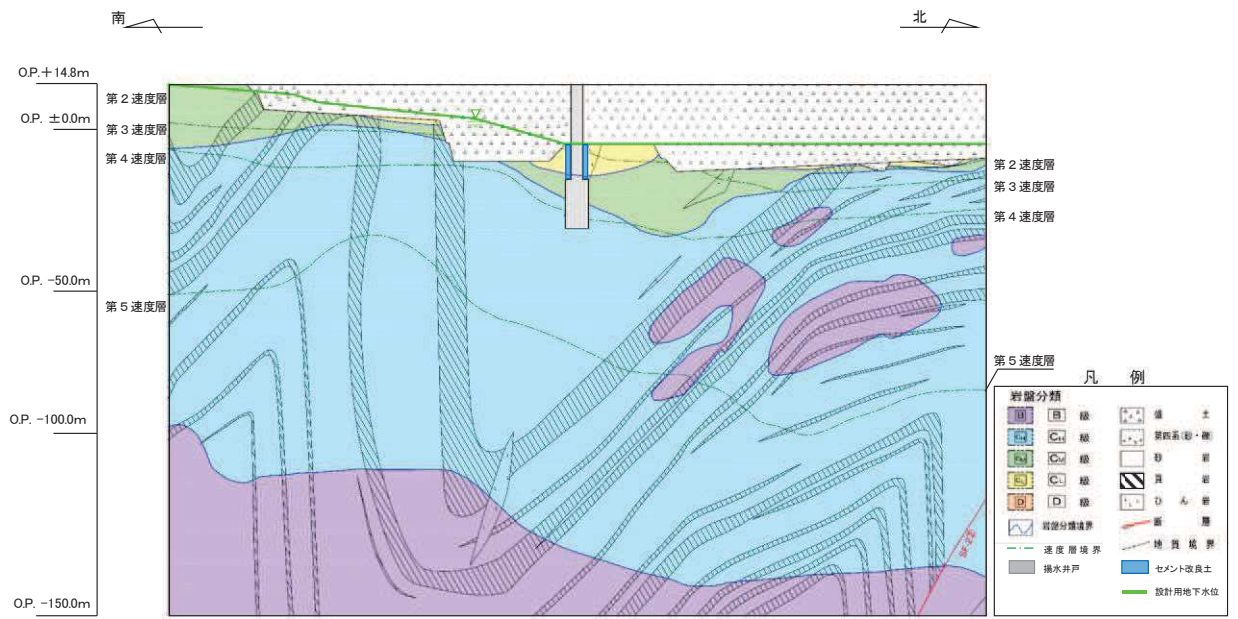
(1) No.1 揚水井戸 評価対象断面図 (A-A' 断面)
